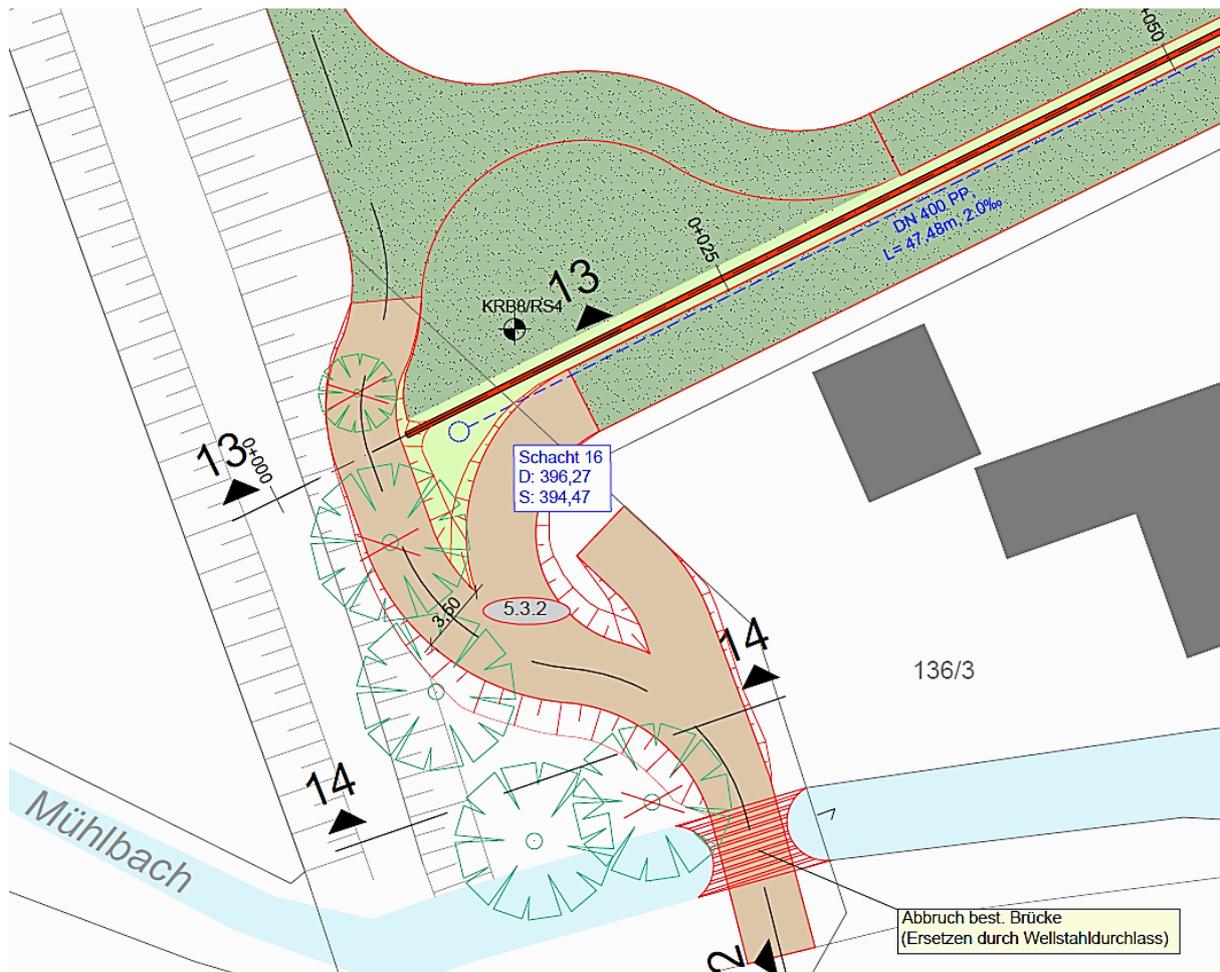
Überfahrt über die Schutzwand (Ausschnitt aus Detaillageplan E22)
